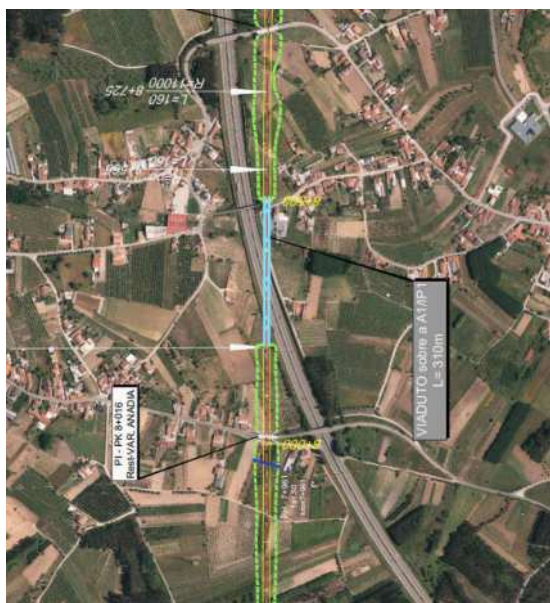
Passagem da Variante de Anadia e do troço inicial da Interligação Var. Anadia – Var O. Bairro, em Couvelha e Paredes do Bairro
